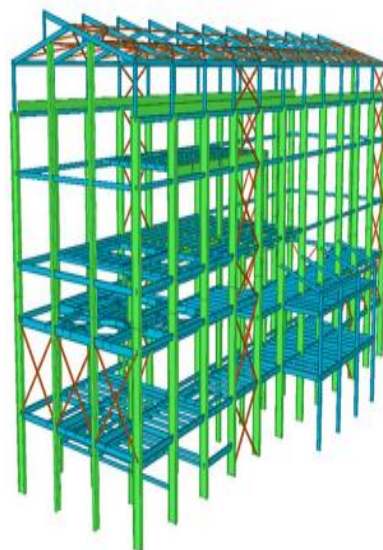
Planta de sinterização da CBMM em Araxá, Minas gerais
